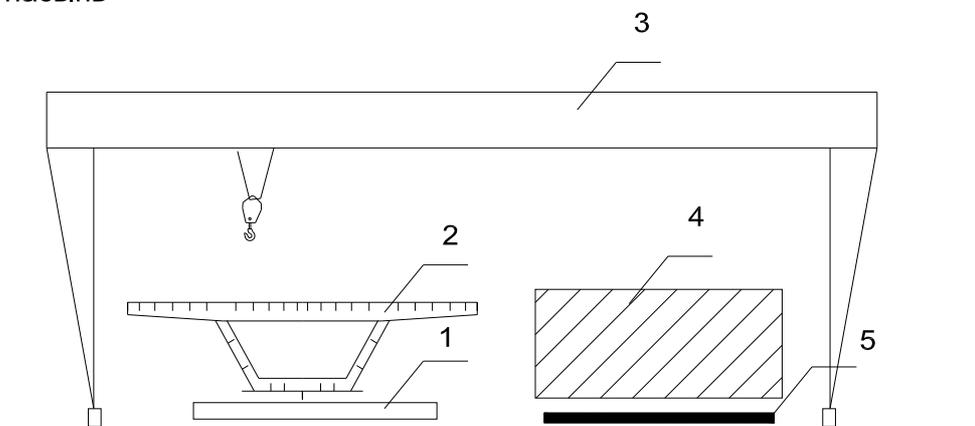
Сборочный стапель (поперечное сечение): 1-сборочный стапель; 2-собираемое пролетное строение; 3-козловый кран; 4-зона подачи конструкции; 5-временная дорога из железобетонных плит шириной 3м
